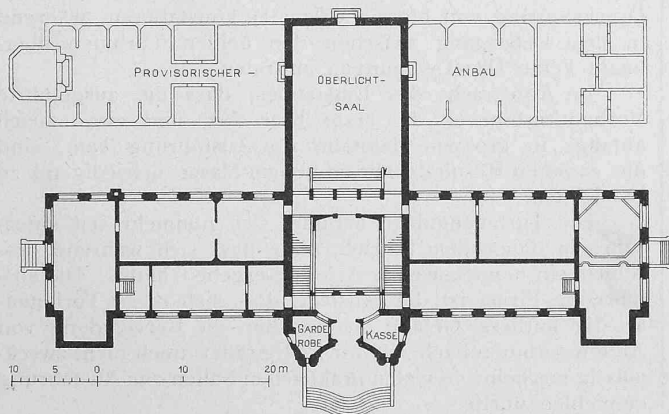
u. 24. Grundrisse vom Erdgeschoss und Obergeschoss der neuen städtischen Kunsthalle in Mannheim.
